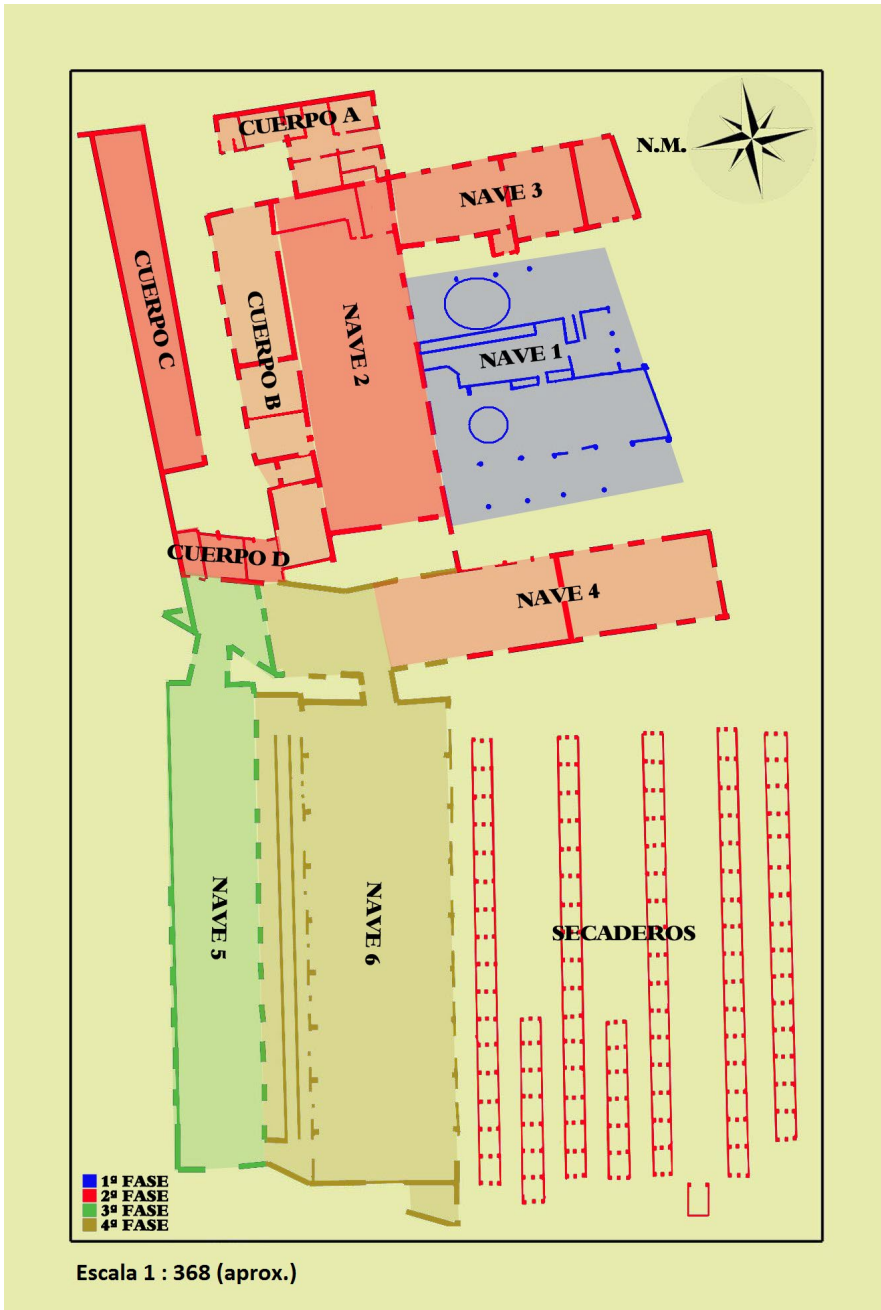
Planta de la fábrica en la que se observan las distintas fases de su construcción. Fuente: elaboración propia a partir de la planta cedida por G. Segura.
